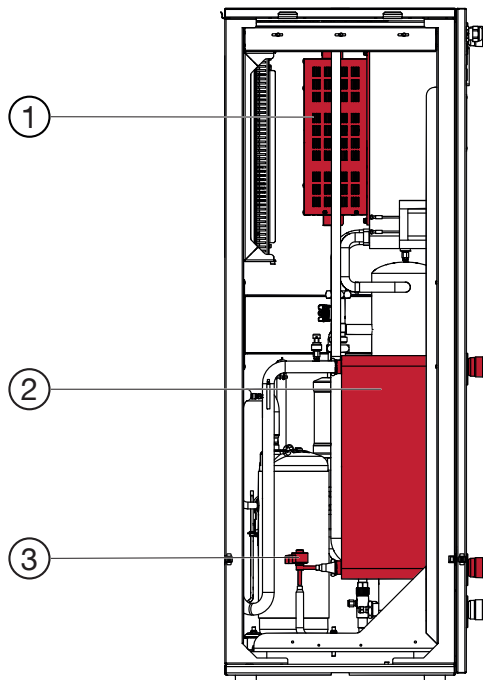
Wärmepumpe geöffnet – Ansicht von rechts
